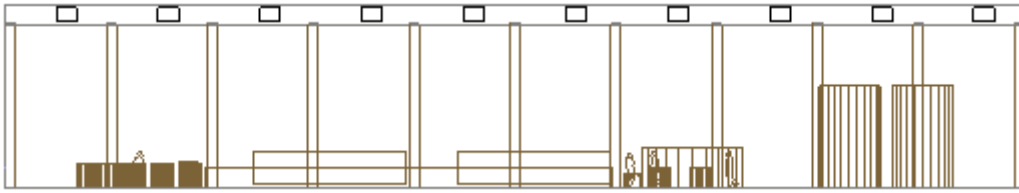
Propuesta 1, vista en planta. Fuente: DIALux
